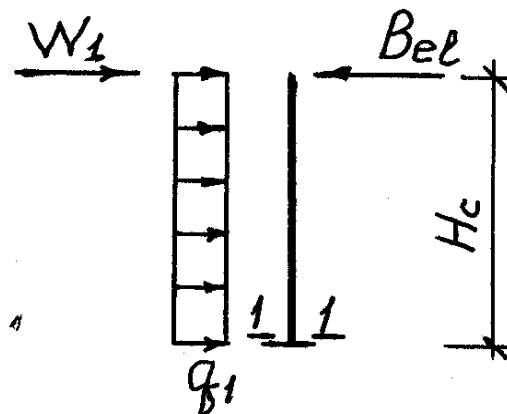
Розрахункова схема колони при визначенні згинального моменту M_w і поперечної сили Q_w у перерізі 1-1
